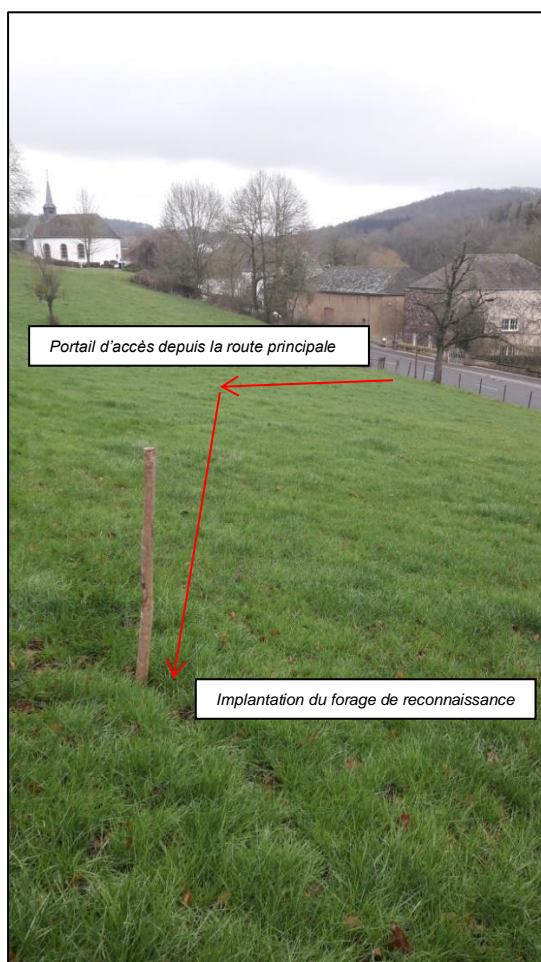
vue sur les accès pour la machine à chenille pour le forage N°1
